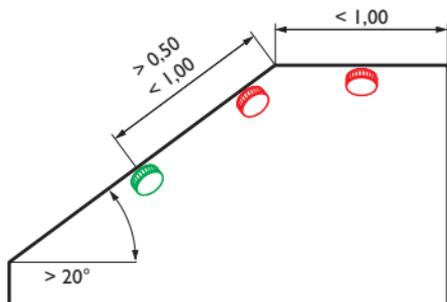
Gerade Montagefläche weniger als 1 m lang und 1 m breit
